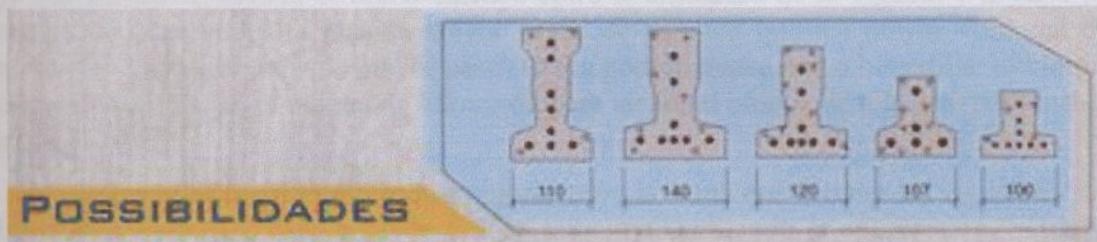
Viguetas, distintos tamaños y distribución de armadura pre-tensada.
